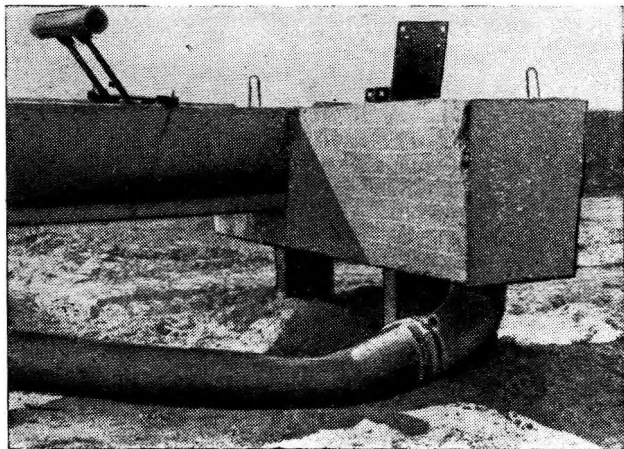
Подсоединение гибкого трубопровода к водовыпуску железобетонного лотка.
